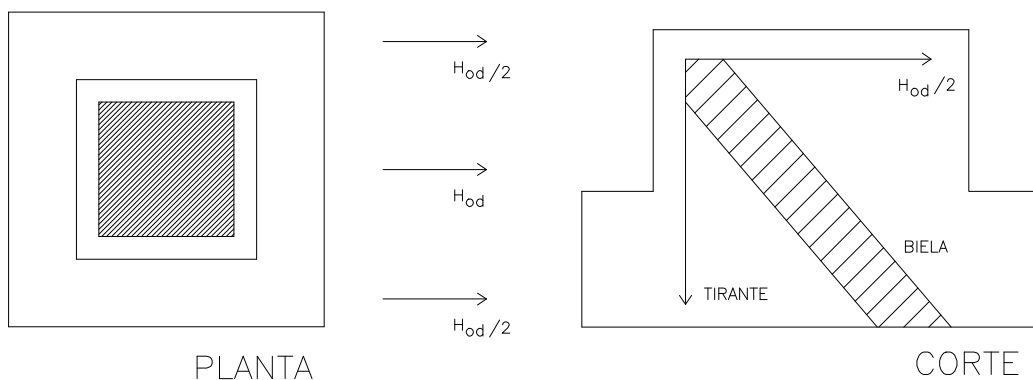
Mecanismo Resistente da Ligação Fundação-Pilar para Paredes Longitudinais Segundo LEONHARDT & MONNIG (1978)
